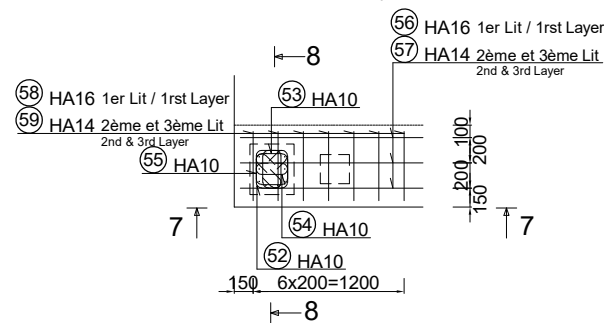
DETAIL ZONE D'APPUI / BEARING SURFACE DETAIL A3: 1/60 ; A1:1/30
